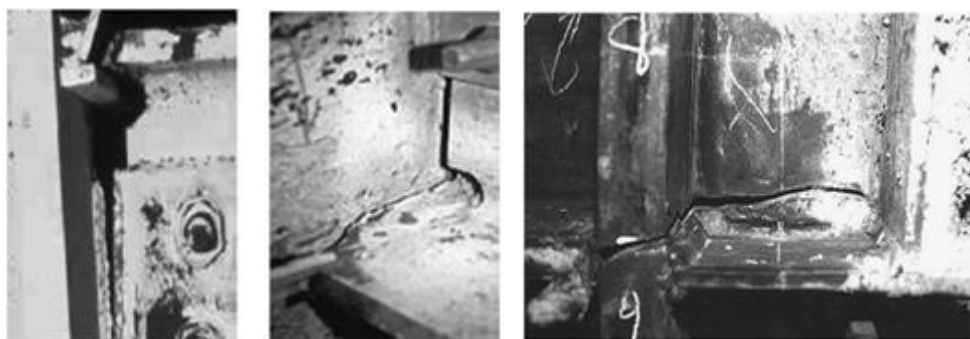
Fallas comunes en las conexiones viga-columna de las estructuras de acero en Northridge. Fuente: [5]
